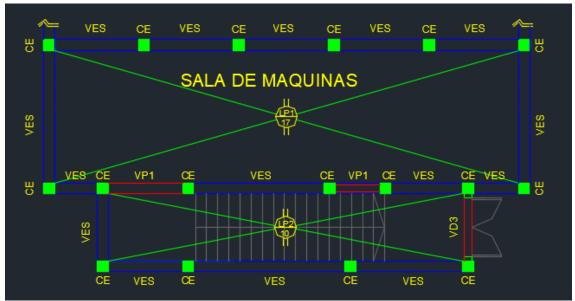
Planta de estructuras para la sala de máquinas de la pileta – proyecto parque este
